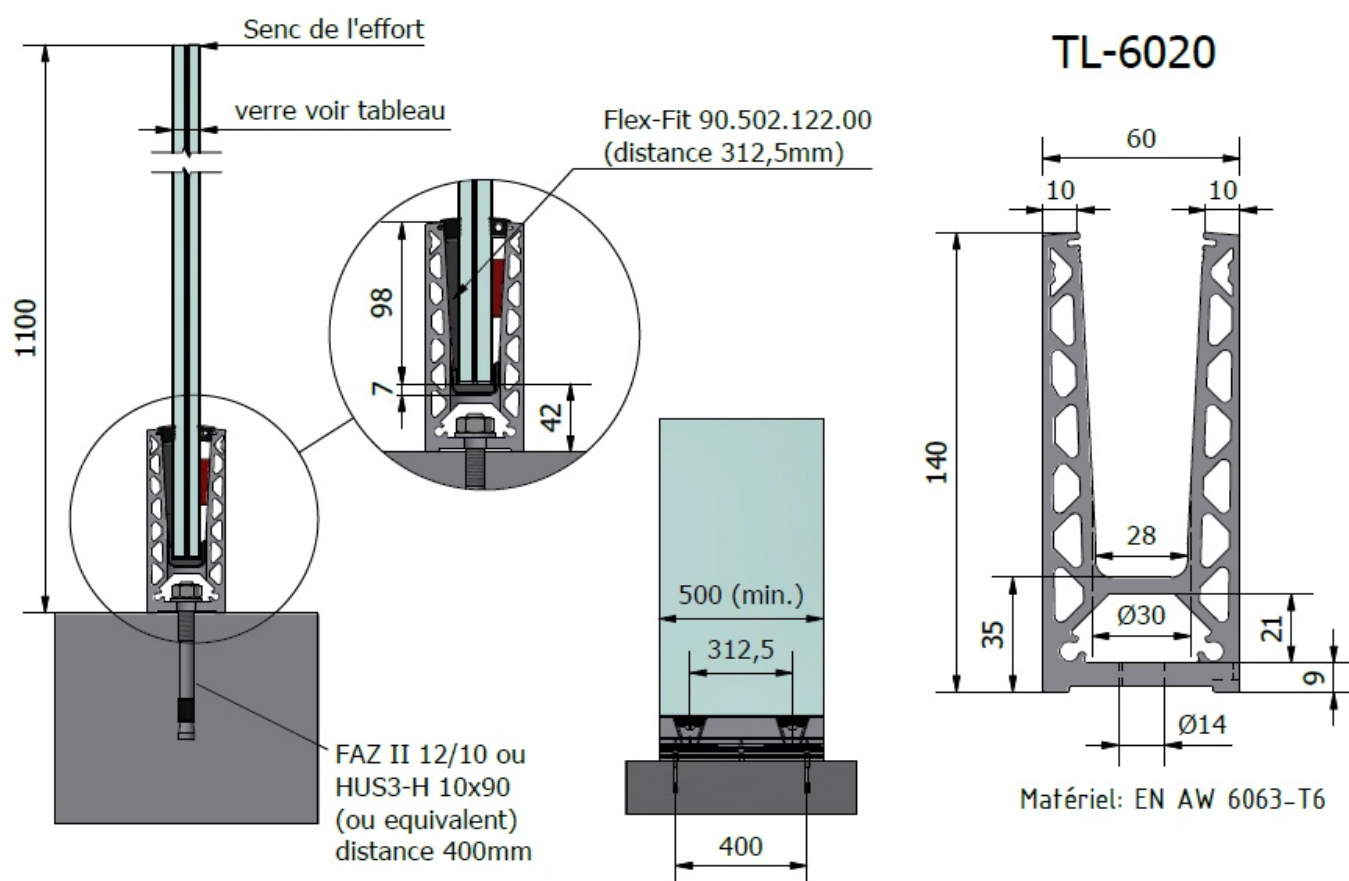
Fixation sur le gros œuvre du système TL-6020 verre de 16.76 mm à 21.52 mm - longueur minimale 500mm
